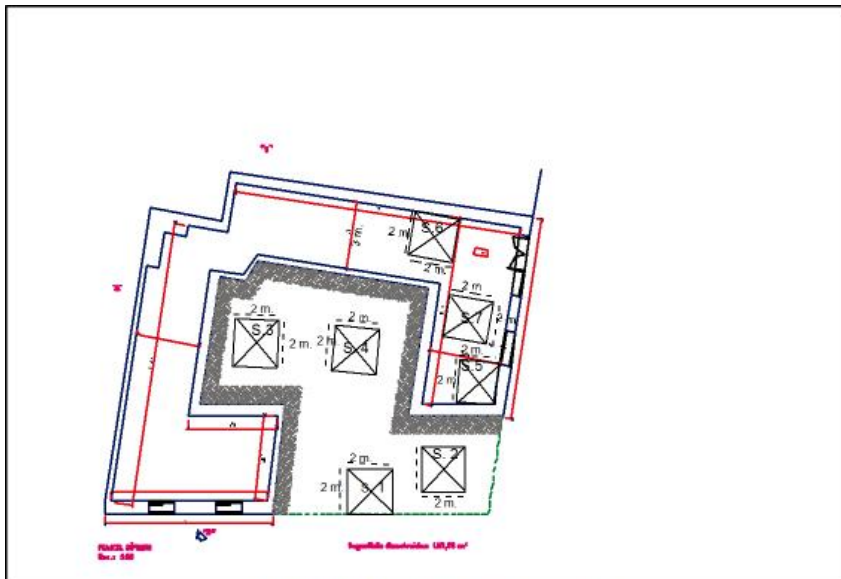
Planteamiento de los sectores de excavación. E. 1:150
